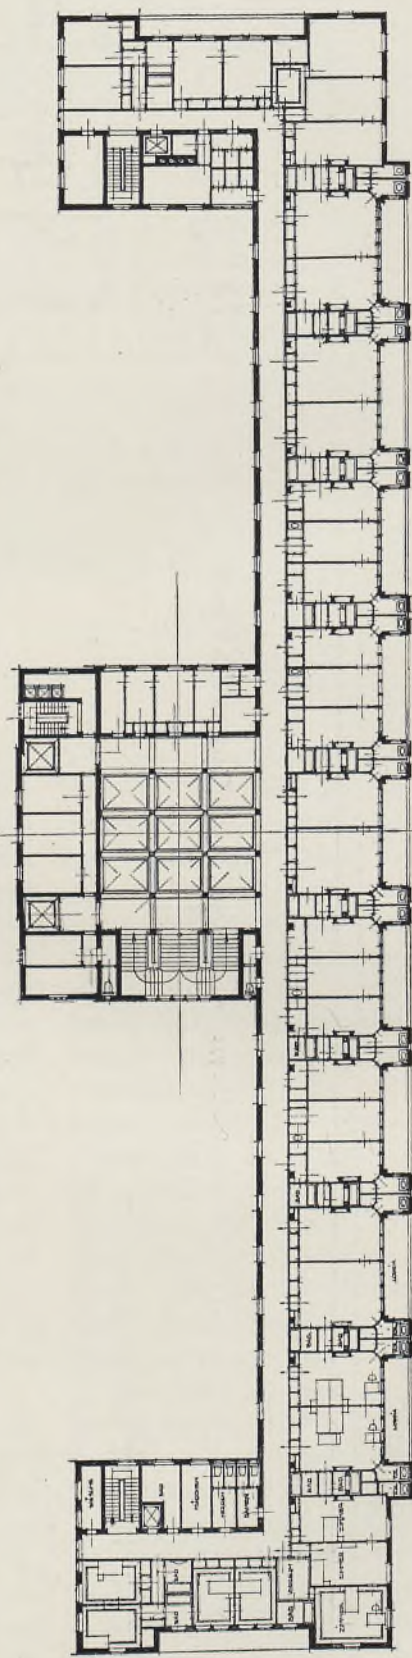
Peter Behrens, Hotelprojekt, Grundriß des vertieften Erdgeschosses.
